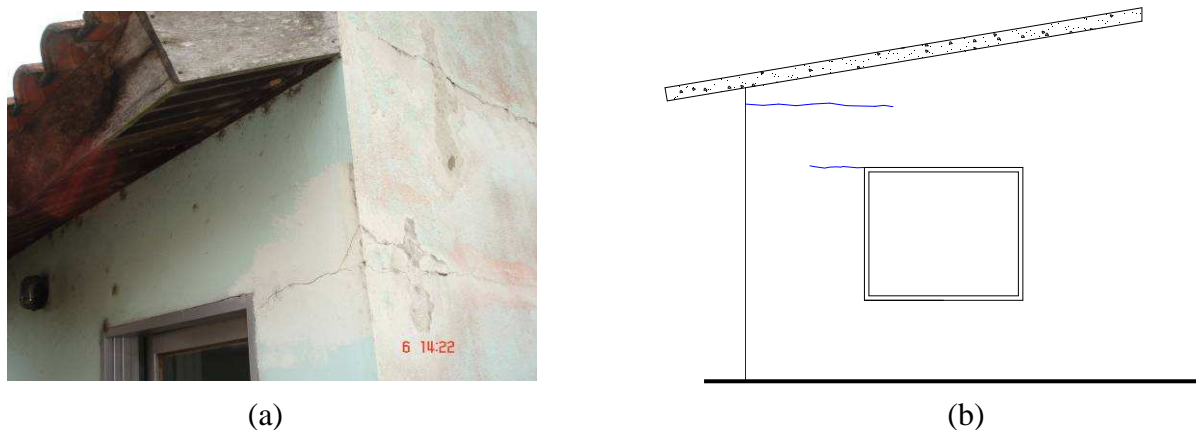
Fissuras devido a retração da laje de cobertura.
